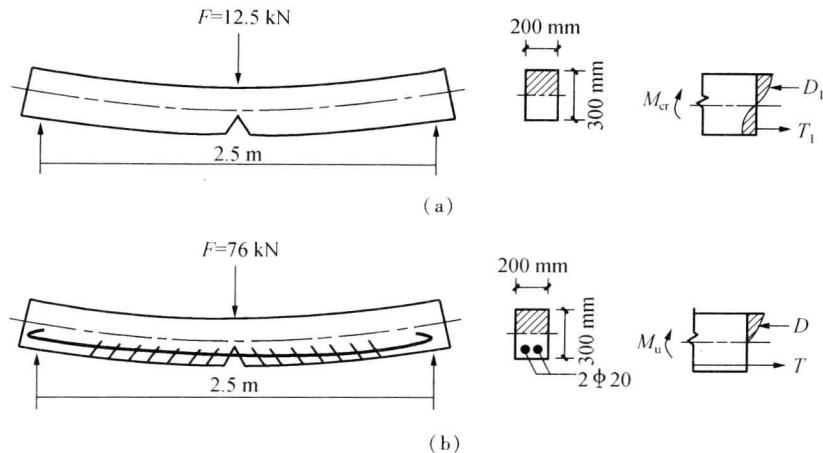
钢筋混凝土梁与素混凝土梁的比较
